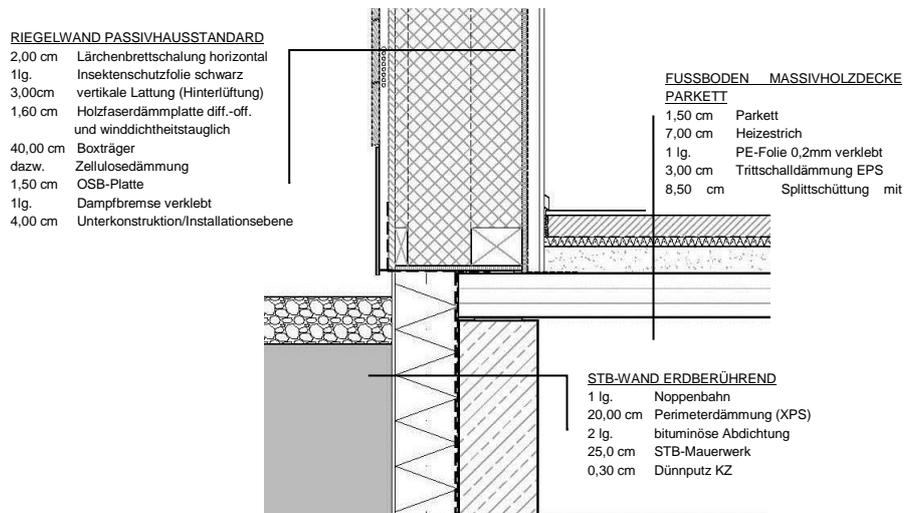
Detailplan Übergang Erdgeschoß – Untergeschoß
